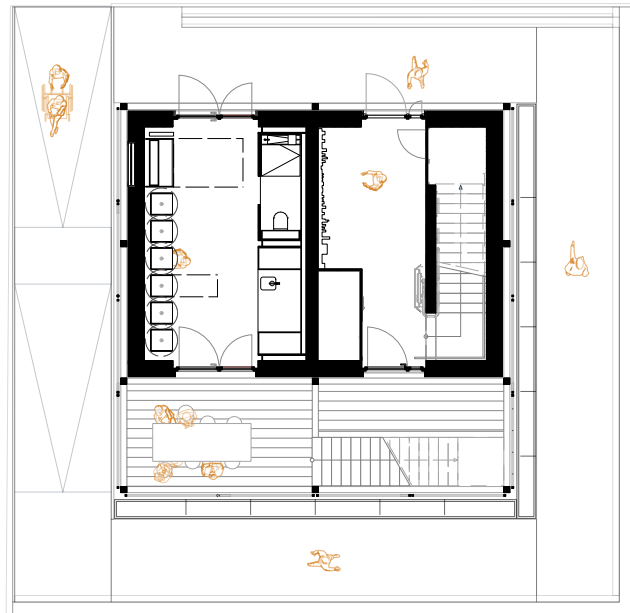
Grundriss Erdgeschoss HDU – 1:200
